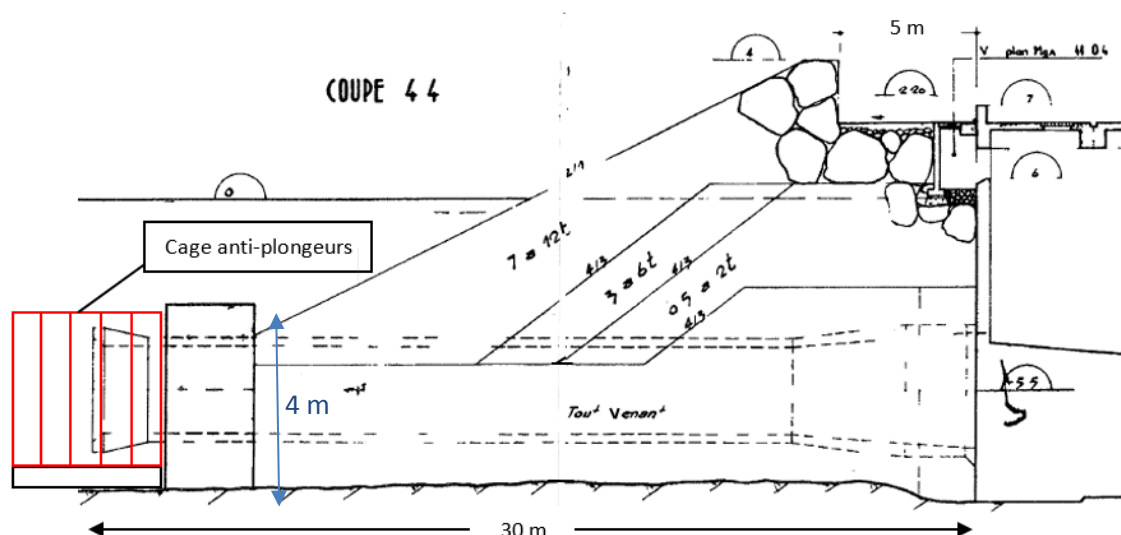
Coupe théorique A-A de la digue de protection de la station de pompage (voir la position sur le plan masse sur la figure précédente)
